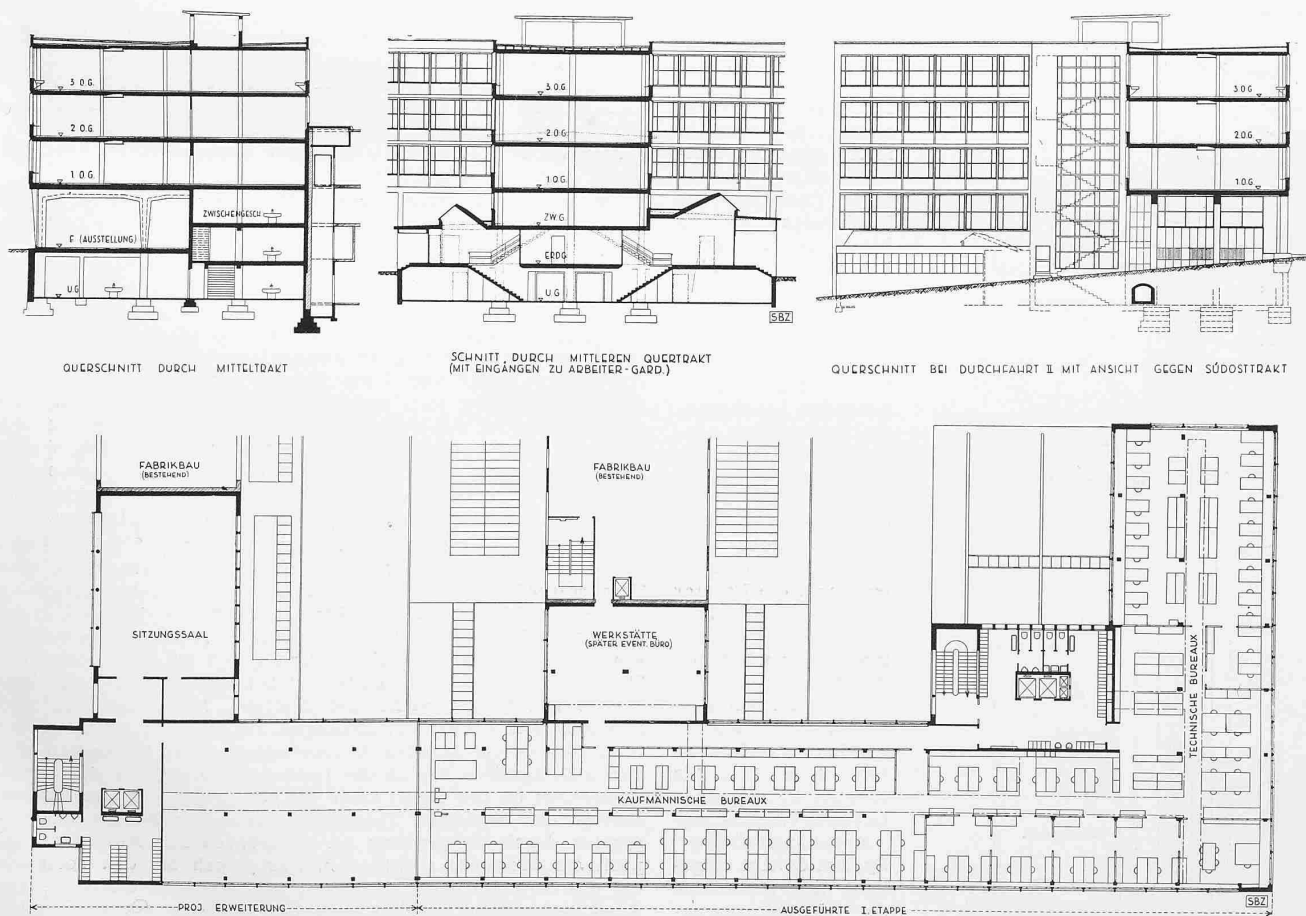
Grundriss vom 1. Obergeschoss. Darüber Abb. 8 bis 10, Schnitte
